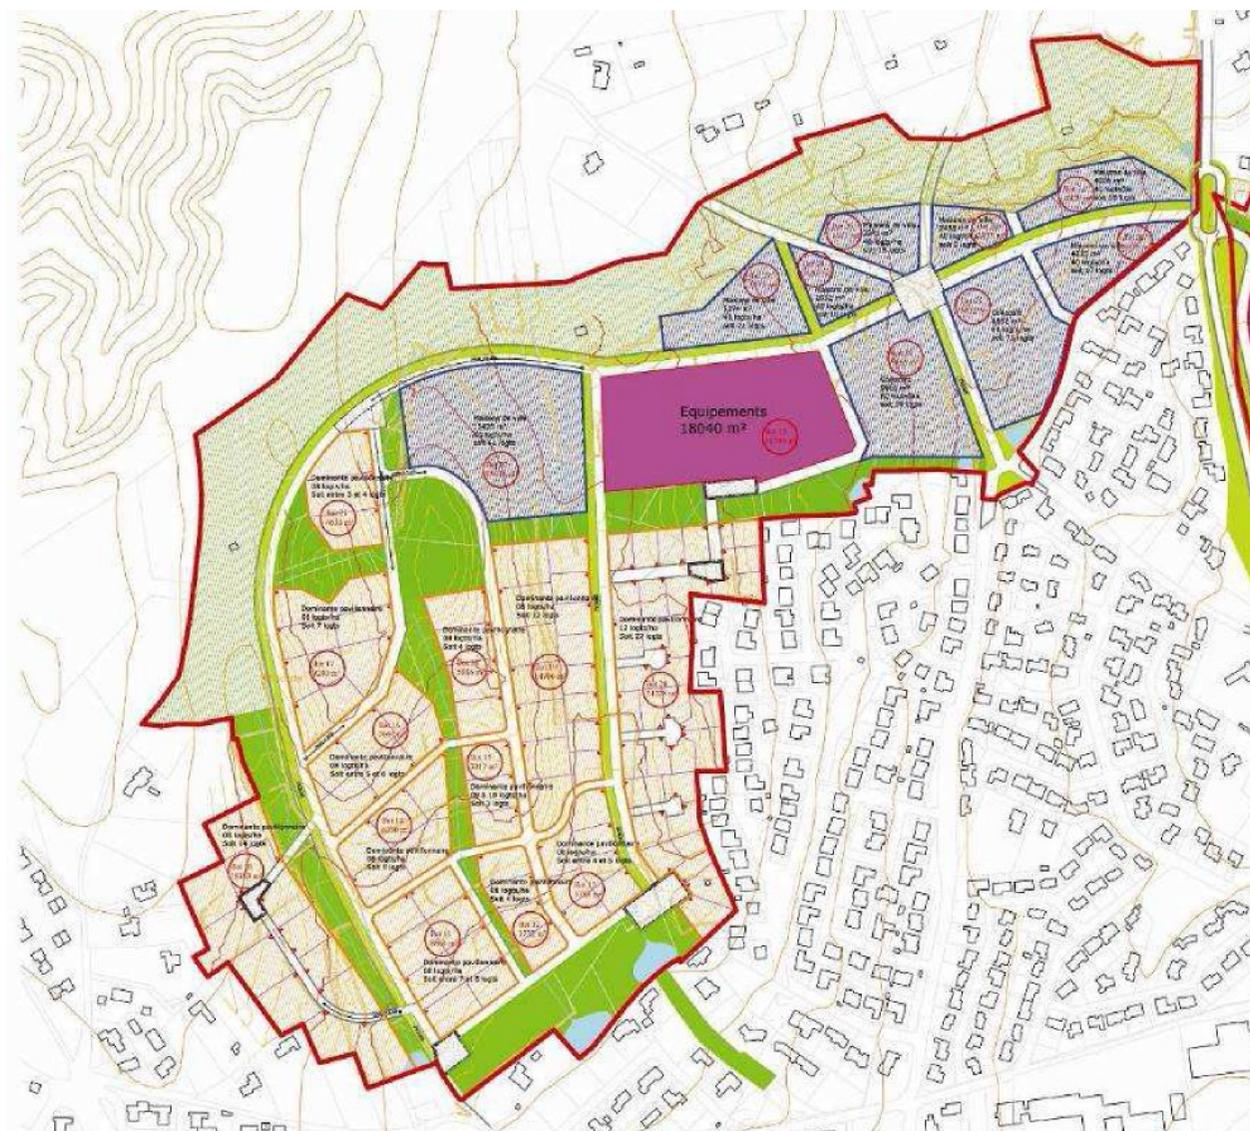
Plan masse au stade création de ZAC - 2006 (source CODRA, 2008)
